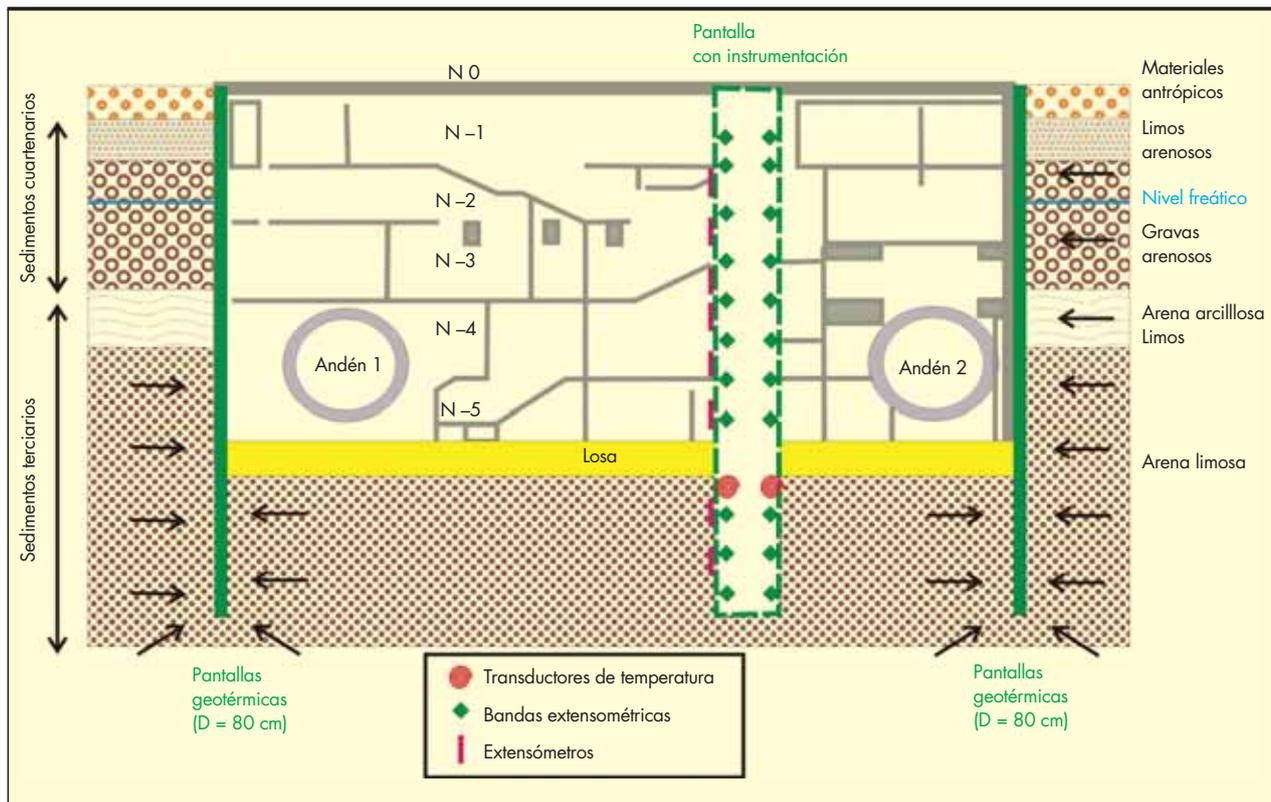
Sección transversal de la estación de metro U2/2-Taborstraße con pantallas termoactivas. Ubicación de los sensores instalados (Basado en: Brandl, 2006).
